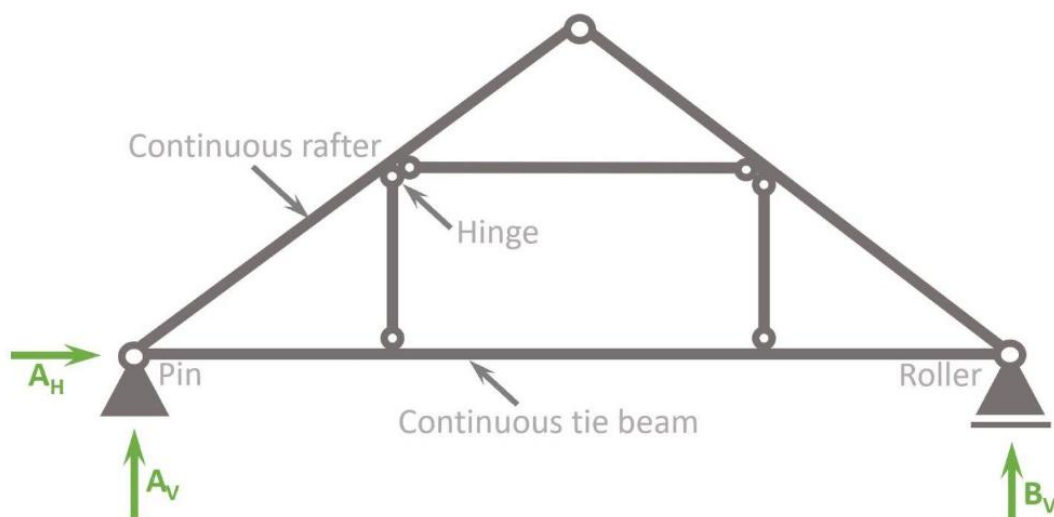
Konstrukcija krovišta stolica oslonjena na armiranobetonsku ploču [5]
